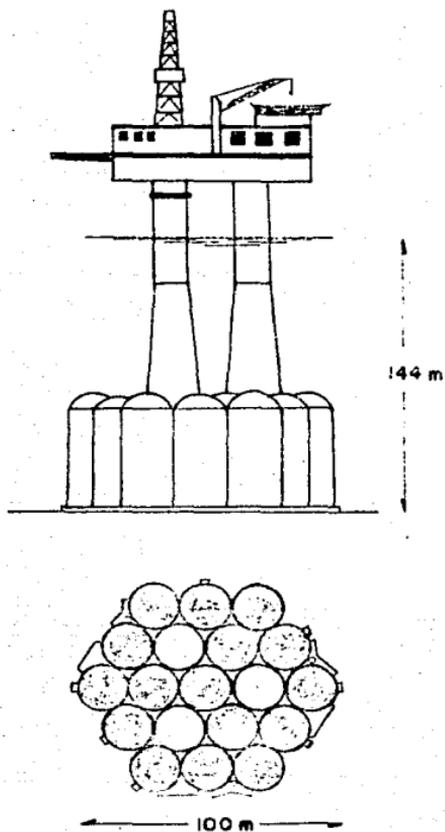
PLATAFORMA DE GRAVEDAD DE CONCRETO
